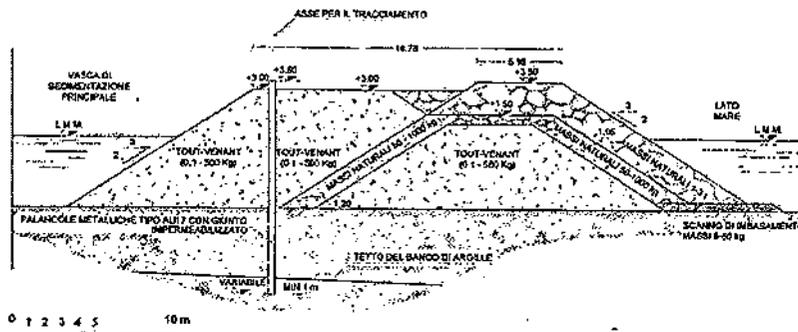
Sezione tipo A1-A1 (sezione corrente diga a scogliera senza protezione interna)
